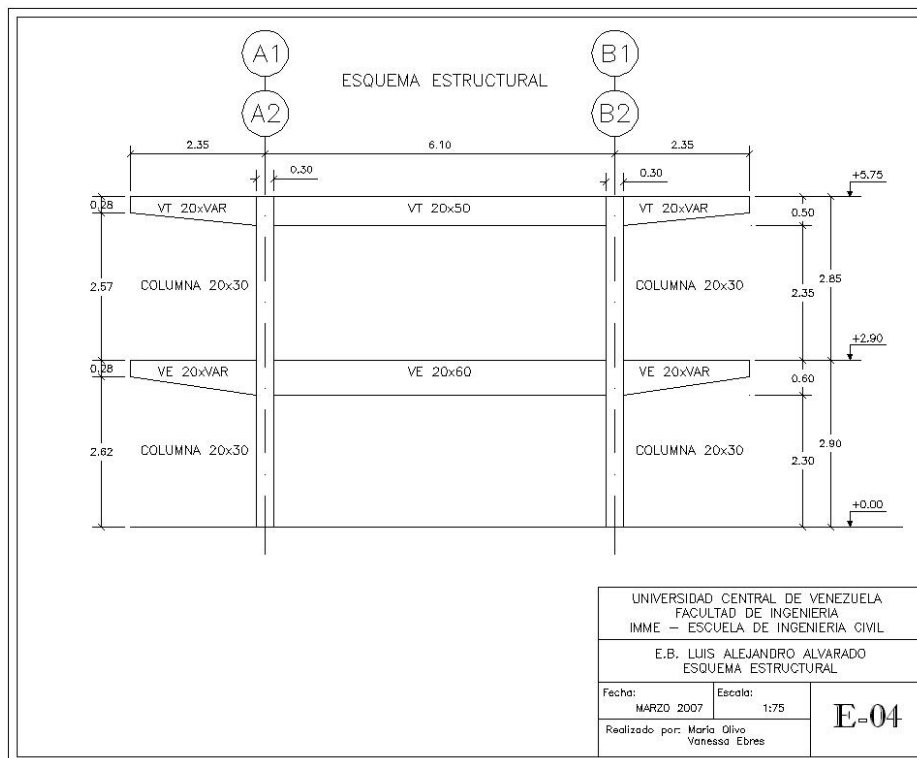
Esquema Estructural de un Alzado Típico.
